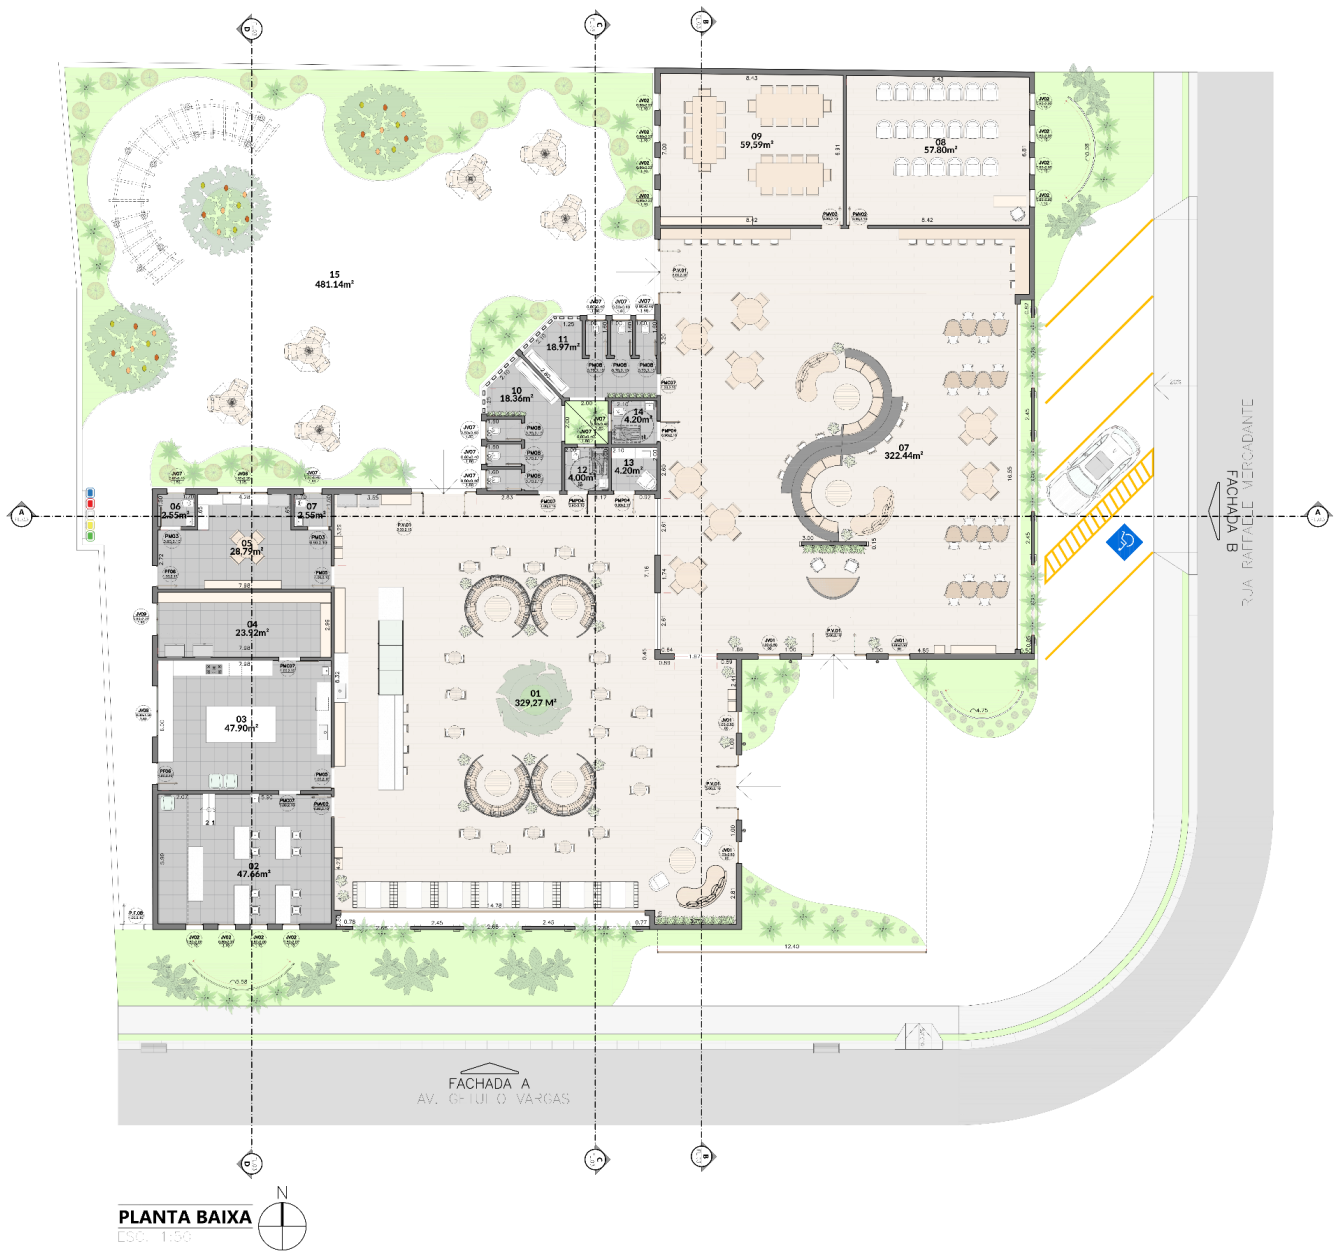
Planta baixa: chocolateria e coworking (fonte autor 2025)
